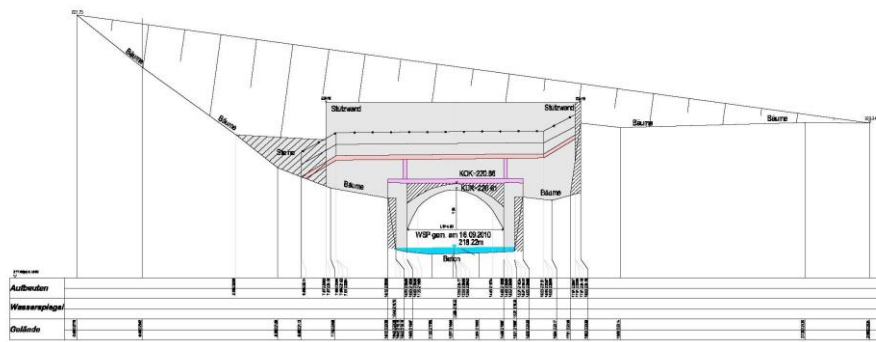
Einlaufbauwerk Ilsetunnel [5]
